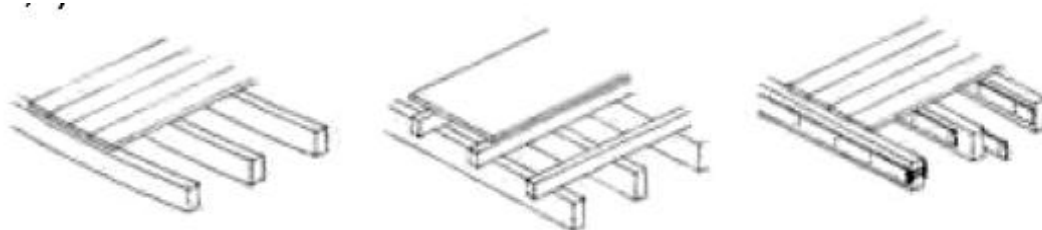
Reforço do pavimento com vigas paralelas e transversais às vigas existentes e com reforço por adição de elementos metálicos [44]
